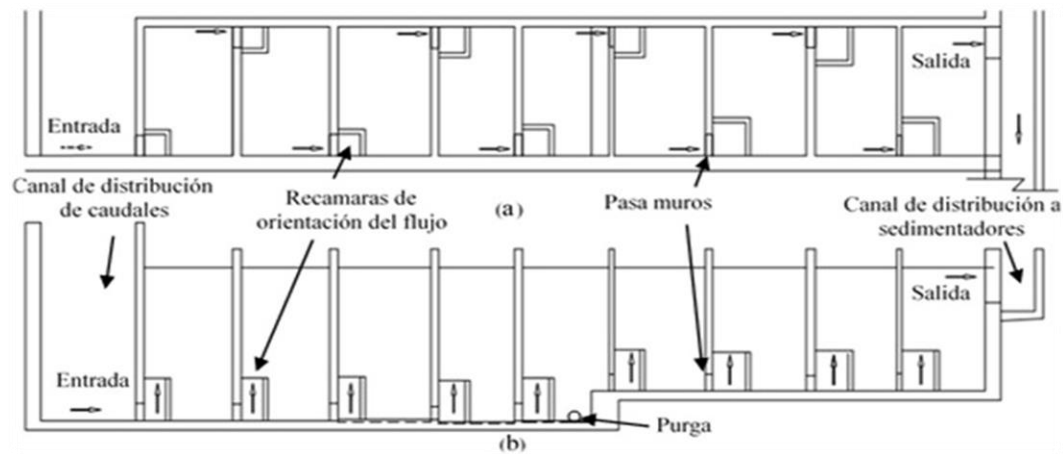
Esquema del floculador dos (a) planta y (b) perfil
